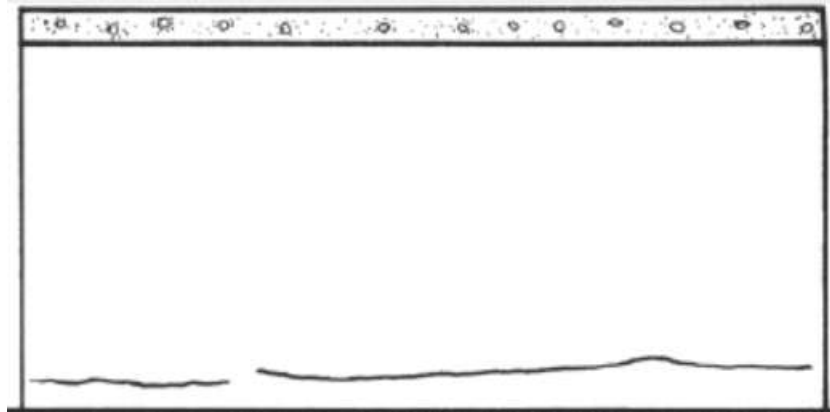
Fissuras por destacamento entre componentes da alvenaria
